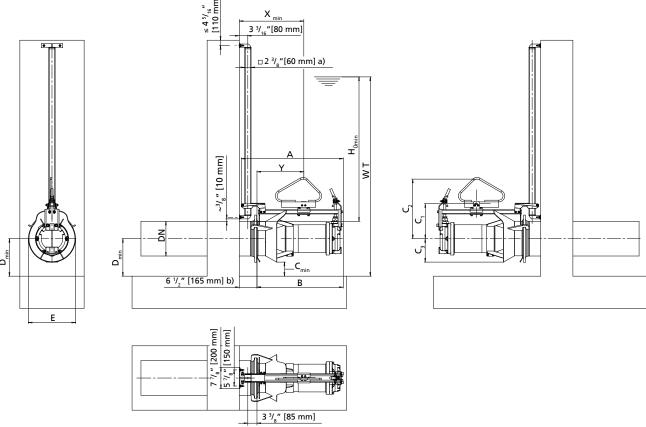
Dimensiones de Amaline 200, 300, 400 - material de la carcasa del motor: fundición gris
